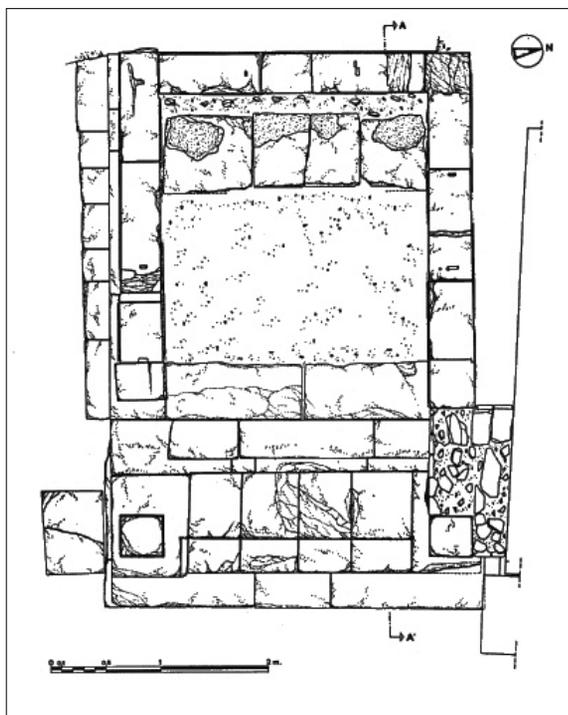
Planimetria del “tempietto K” (Acquaro e Finzi 1986).
